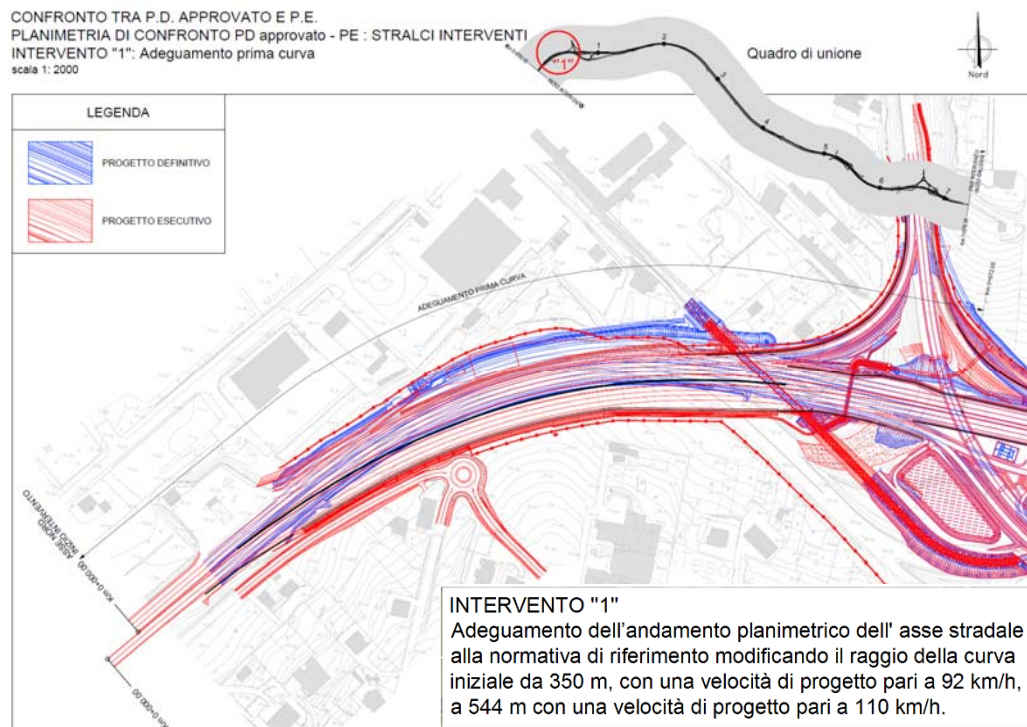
Sovrapposto planimetrico tra PD e PE nella zona Intervento 1
